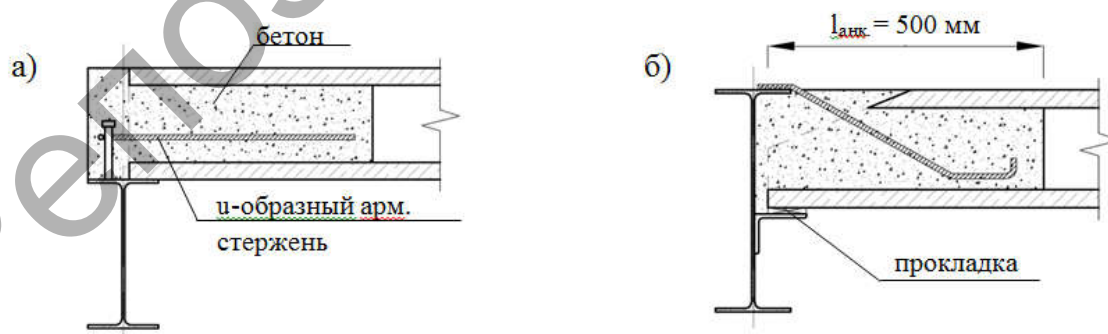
Закрепление сборной железобетонной плиты со стальным ригелем
